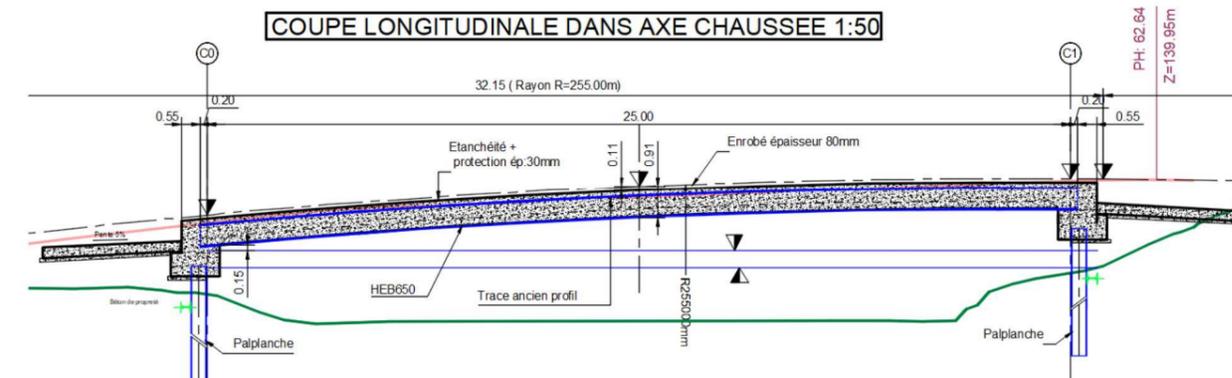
Coupe longitudinale du futur OA Eglise Rouge (AVP)
